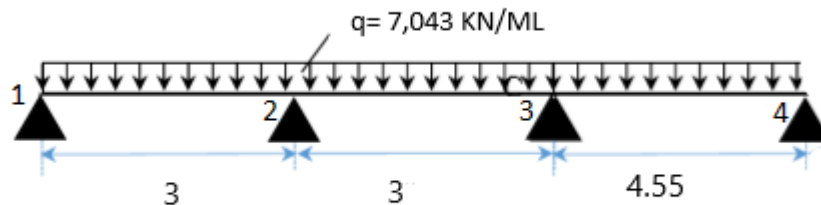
Coupe transversale de la poutrelle à 3 travées.
